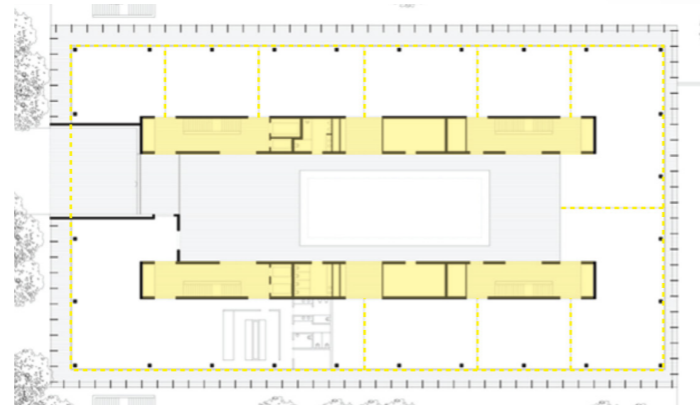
, Planta tipo conjunto Hötting - West, Innsbruck, Baumschläger y Eberle, Austria, 2000
